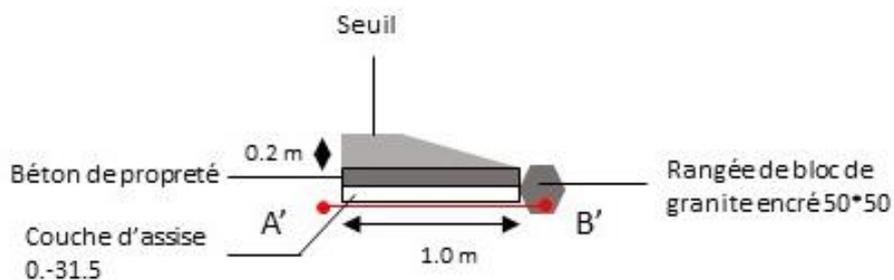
Schéma de l'ouvrage amont de répartition en hautes eaux - coupe en plan
